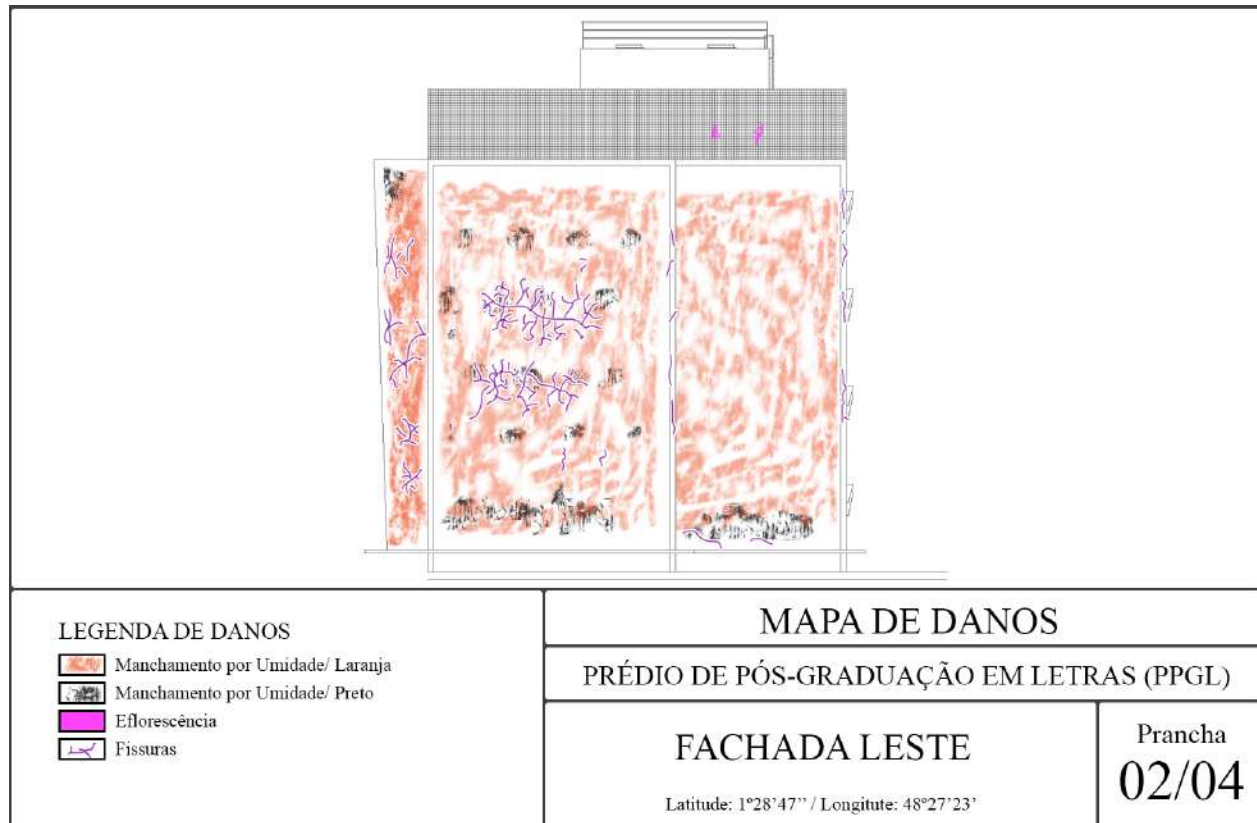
MDs da fachada leste. Fonte: Autores (2021).
